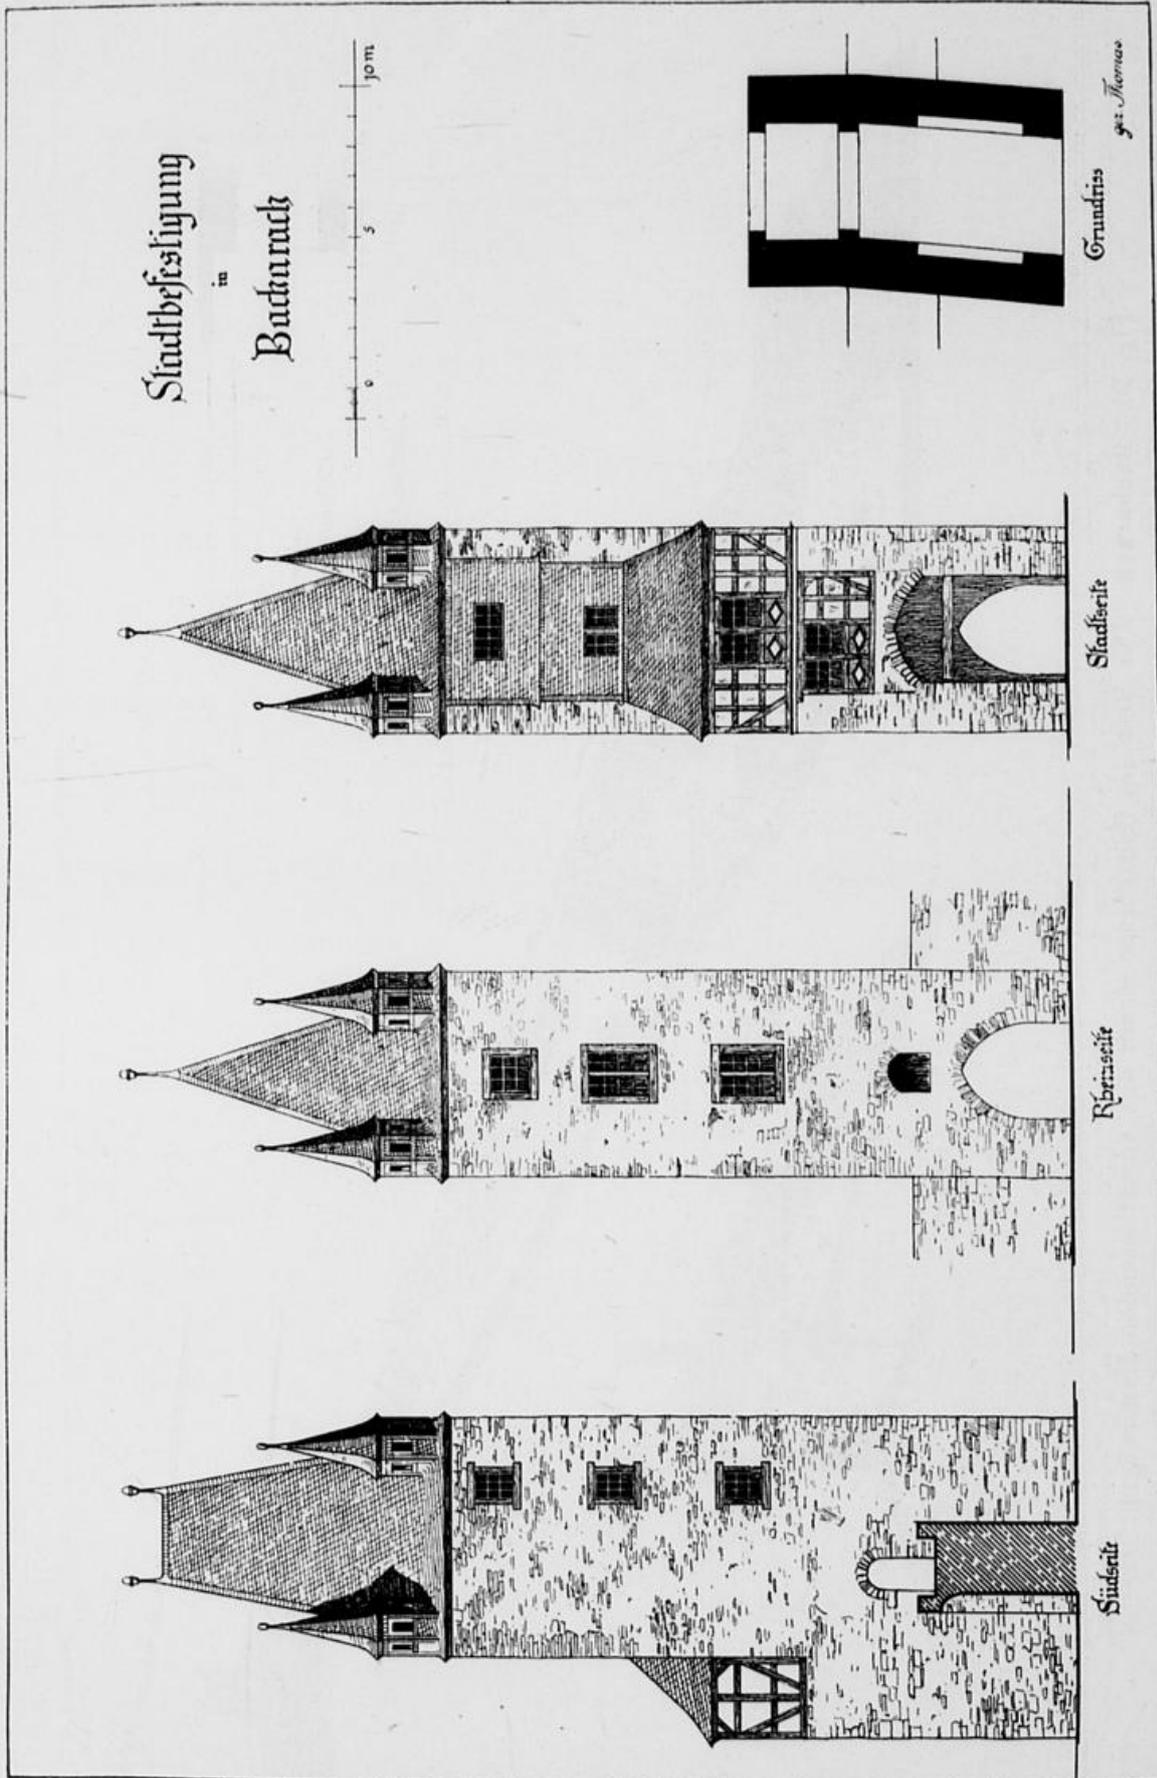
Bacharach. Aufrisse und Grundriss des Marktturmes nach der Wiederherstellung.
